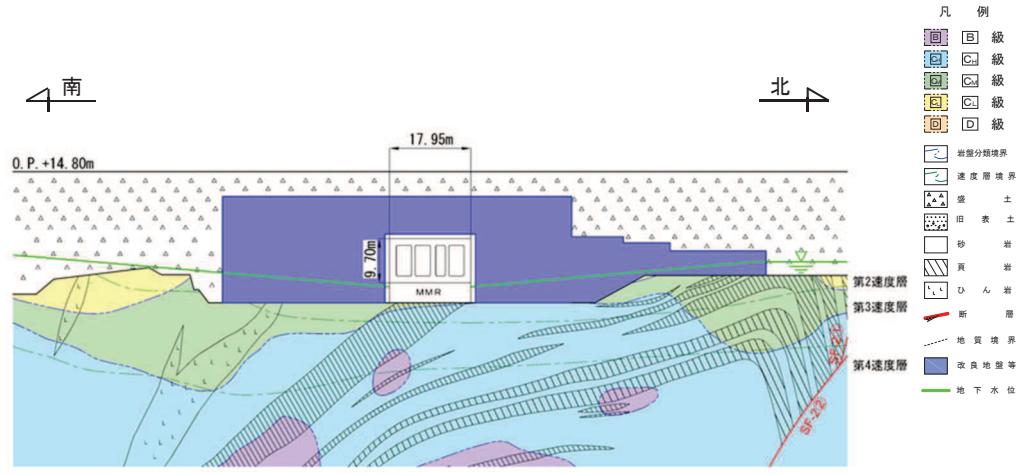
原子炉機器冷却海水配管ダクト（水平部）地質断面図（A-A）
